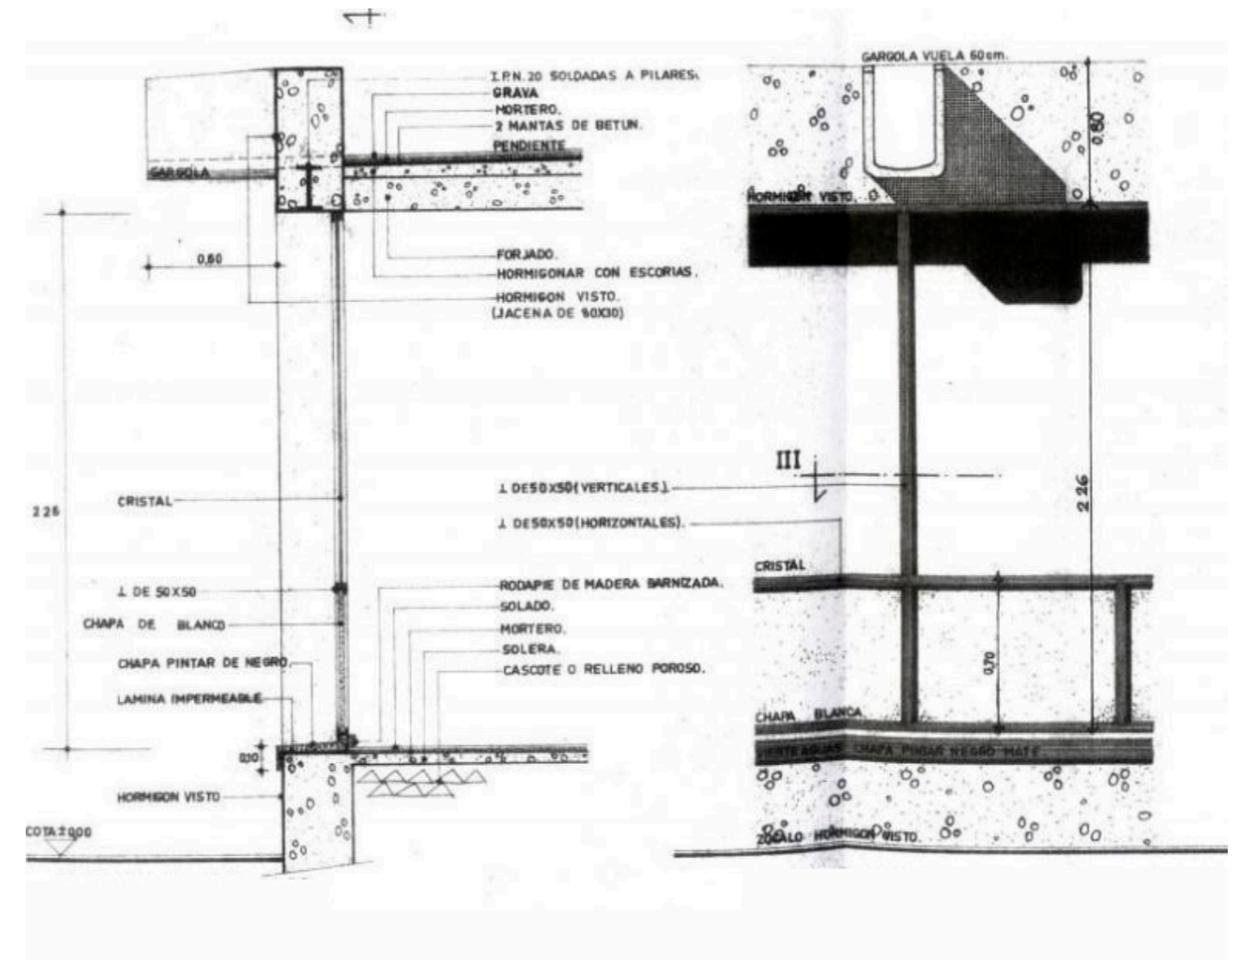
De izquierda a derecha: sección de la fachada, alzado de la entrada, escala 1:20
